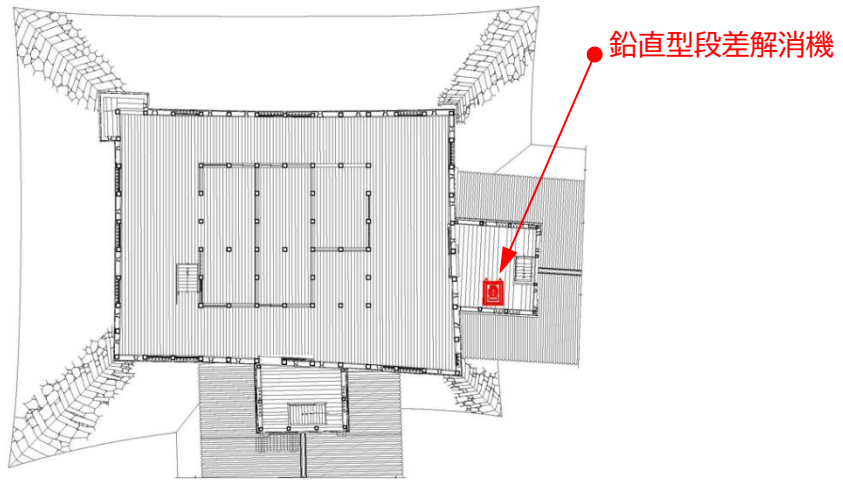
天守1階平面図及び東廊下・南廊下2階平面図
